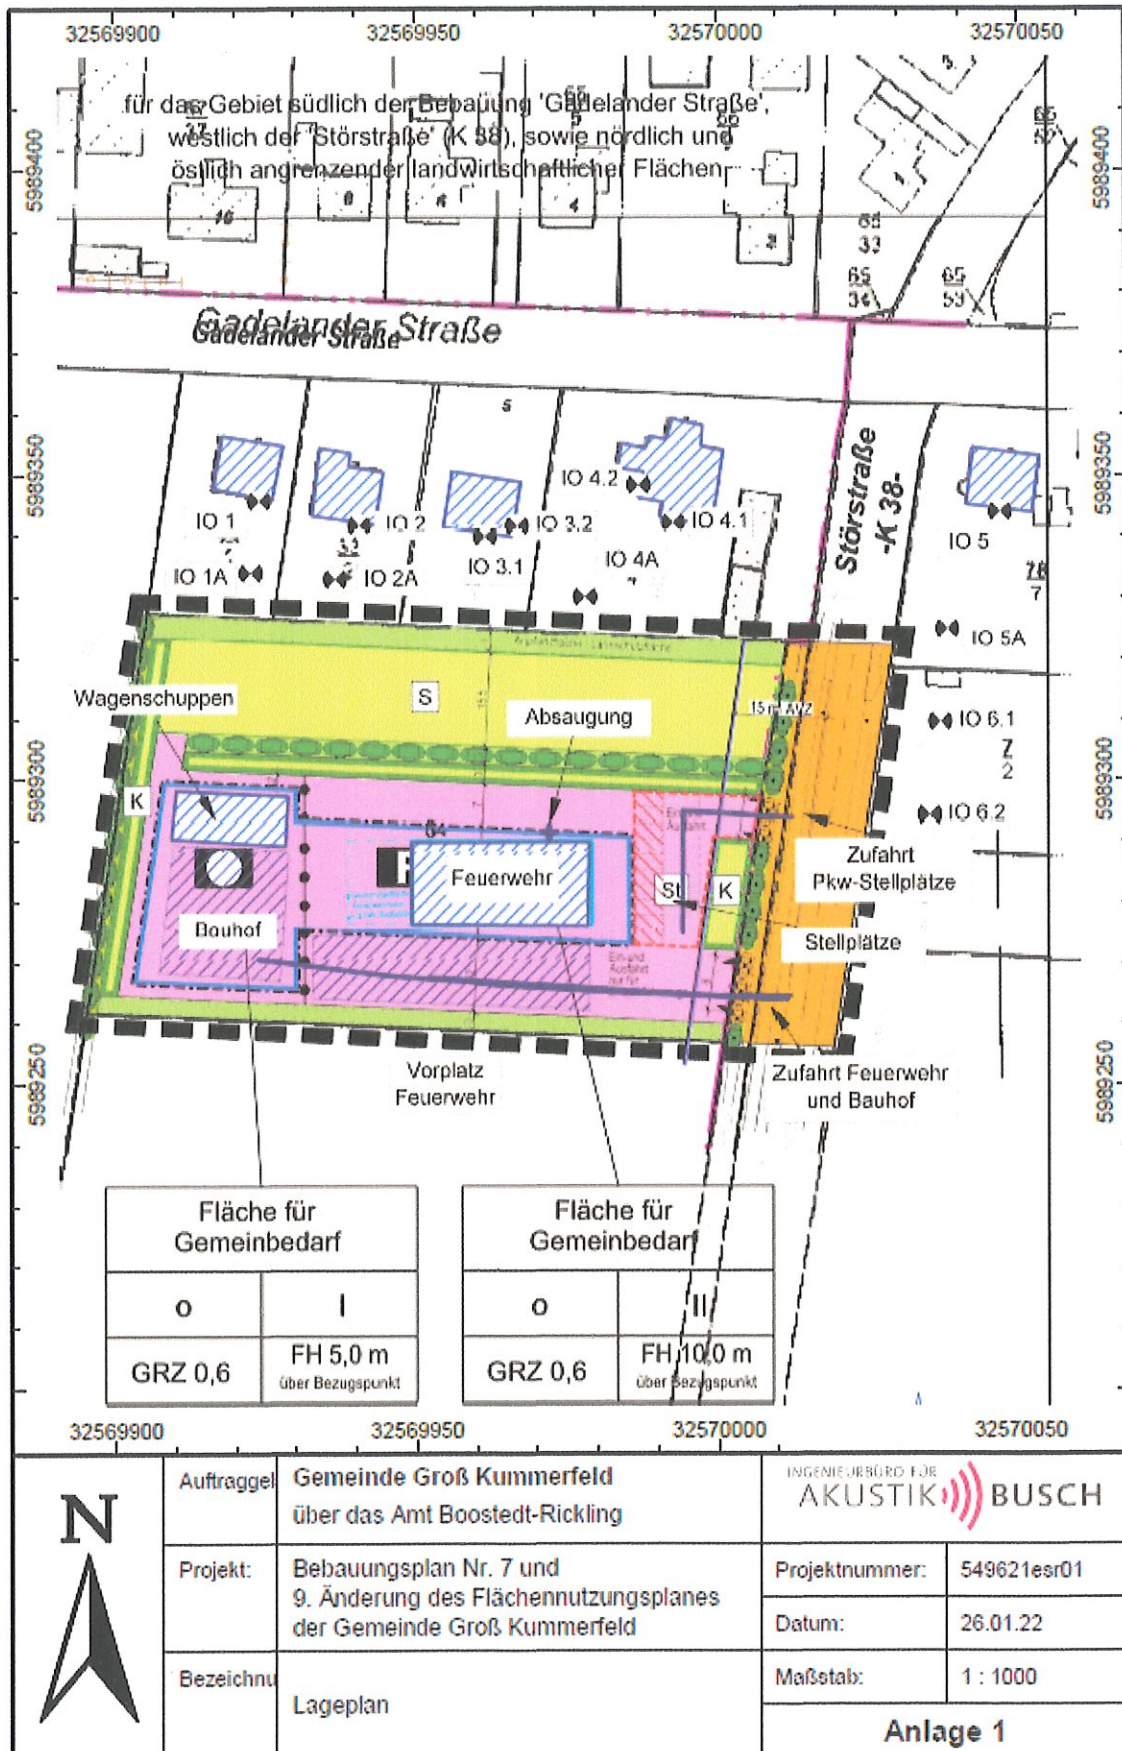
Anlage 1 'Lageplan' zur Schalltechnischen Untersuchung vom 09.02.2022
